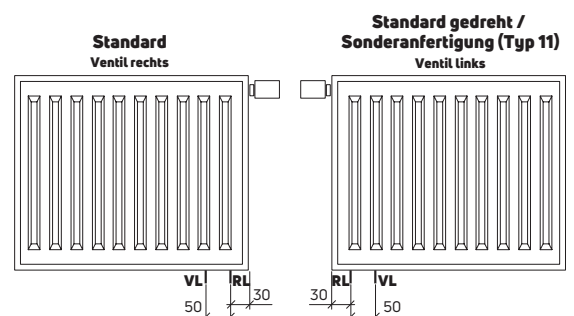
Anschlusslage Ventil rechts und Ventil links
